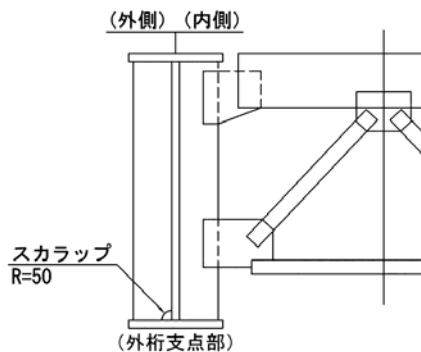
外桁支点部垂直補剛材の外側に設けるスカラップの例
